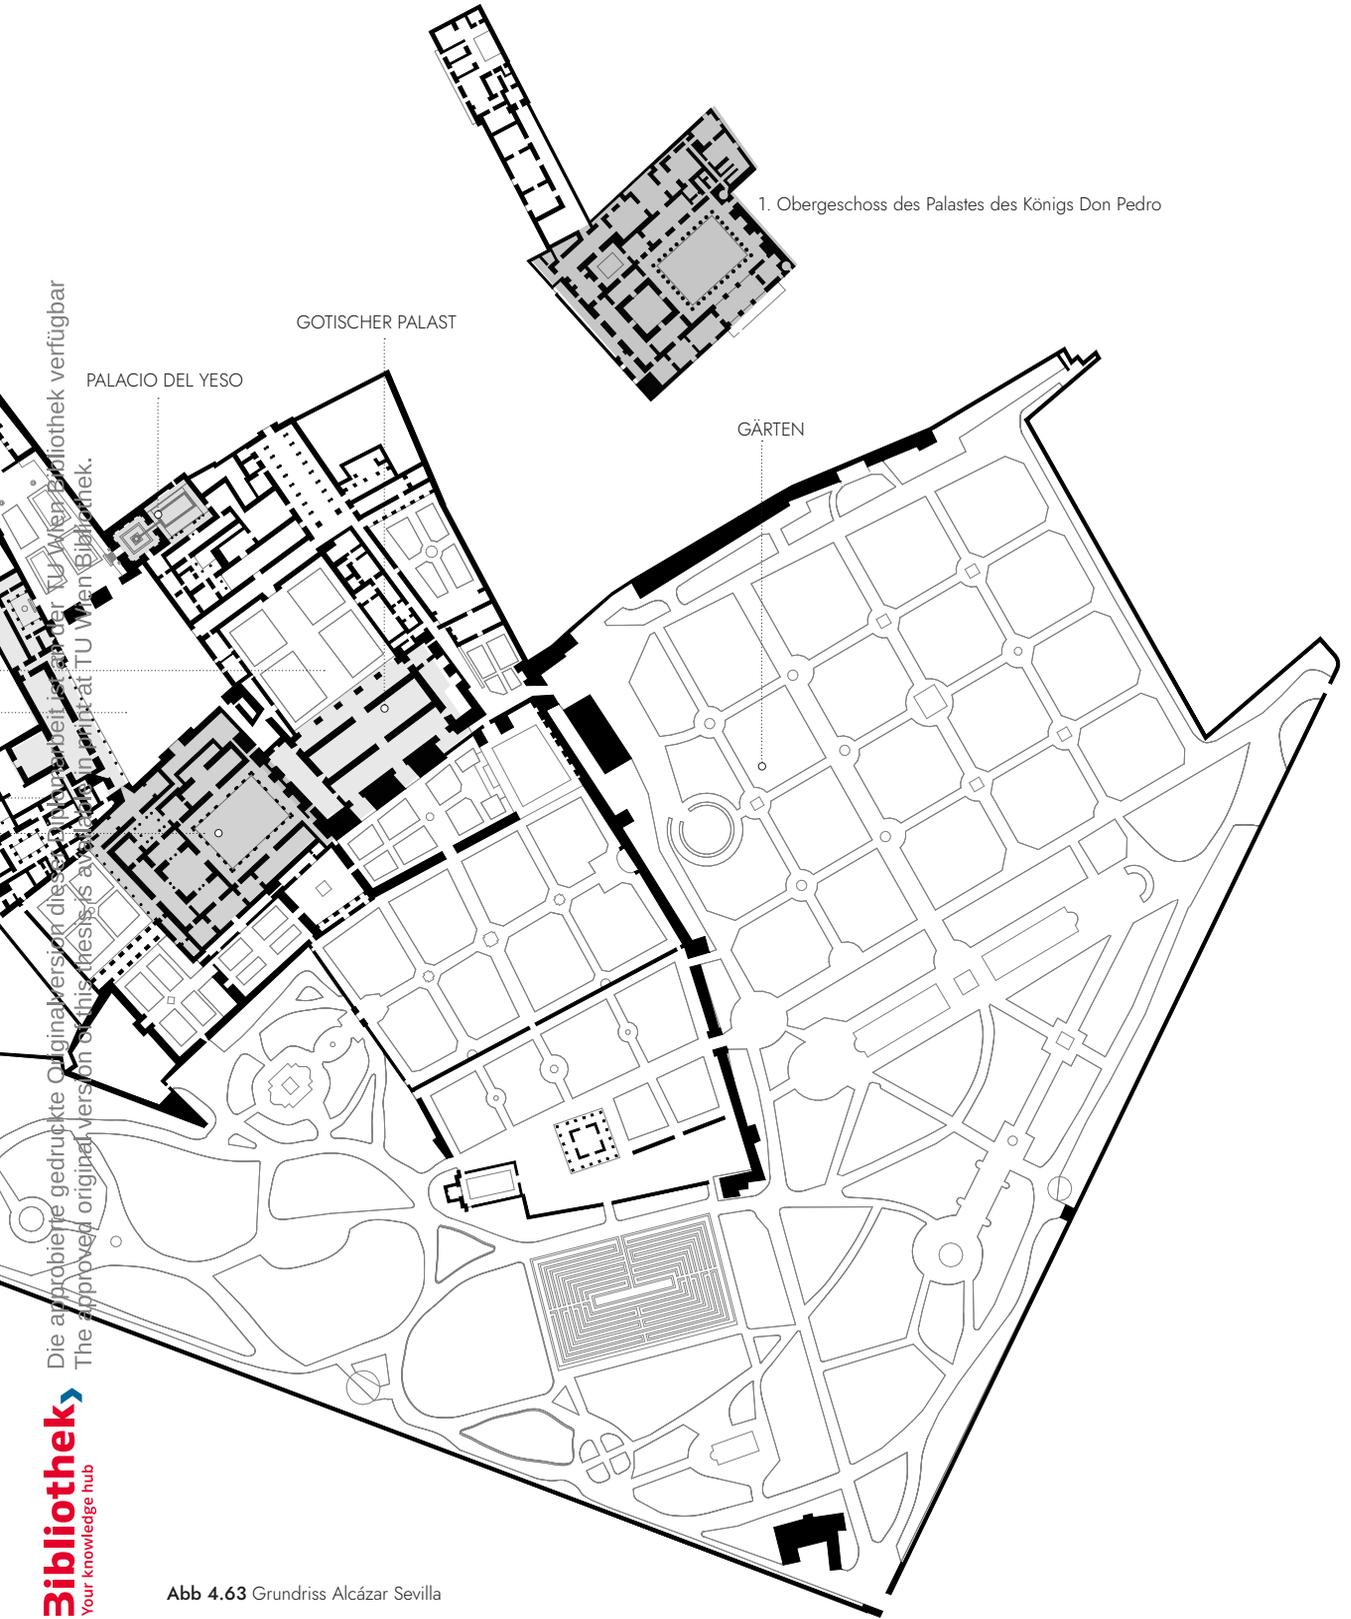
Grundriss Alcázar Sevilla
